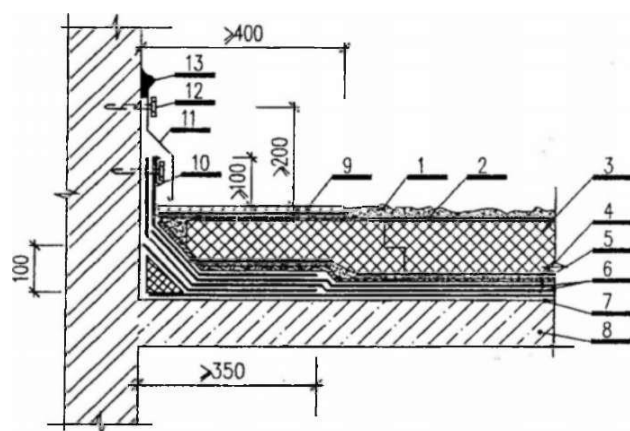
Примыкание инверсионной кровли с двухслойным водоизоляционным ковром
